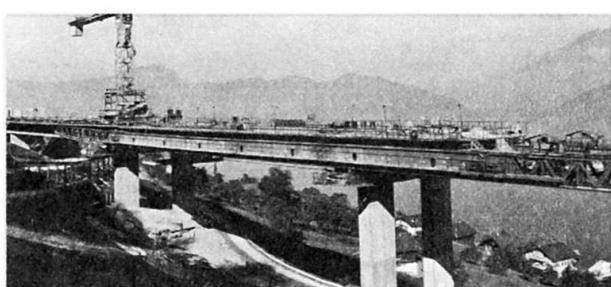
Vorschubgerüst im Feld 25 (10.11.78). Laufkatzkran mit 67 m Ausladung
